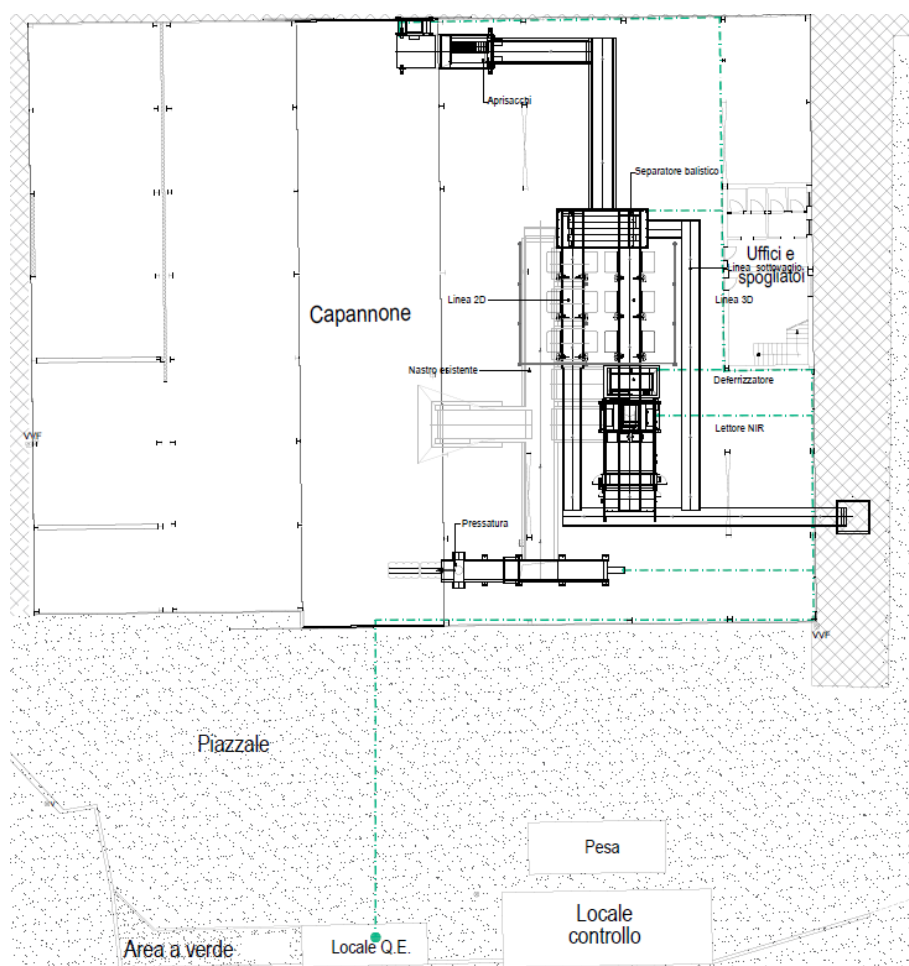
Pianta con indicazione del cavo elettrico (in verde)
